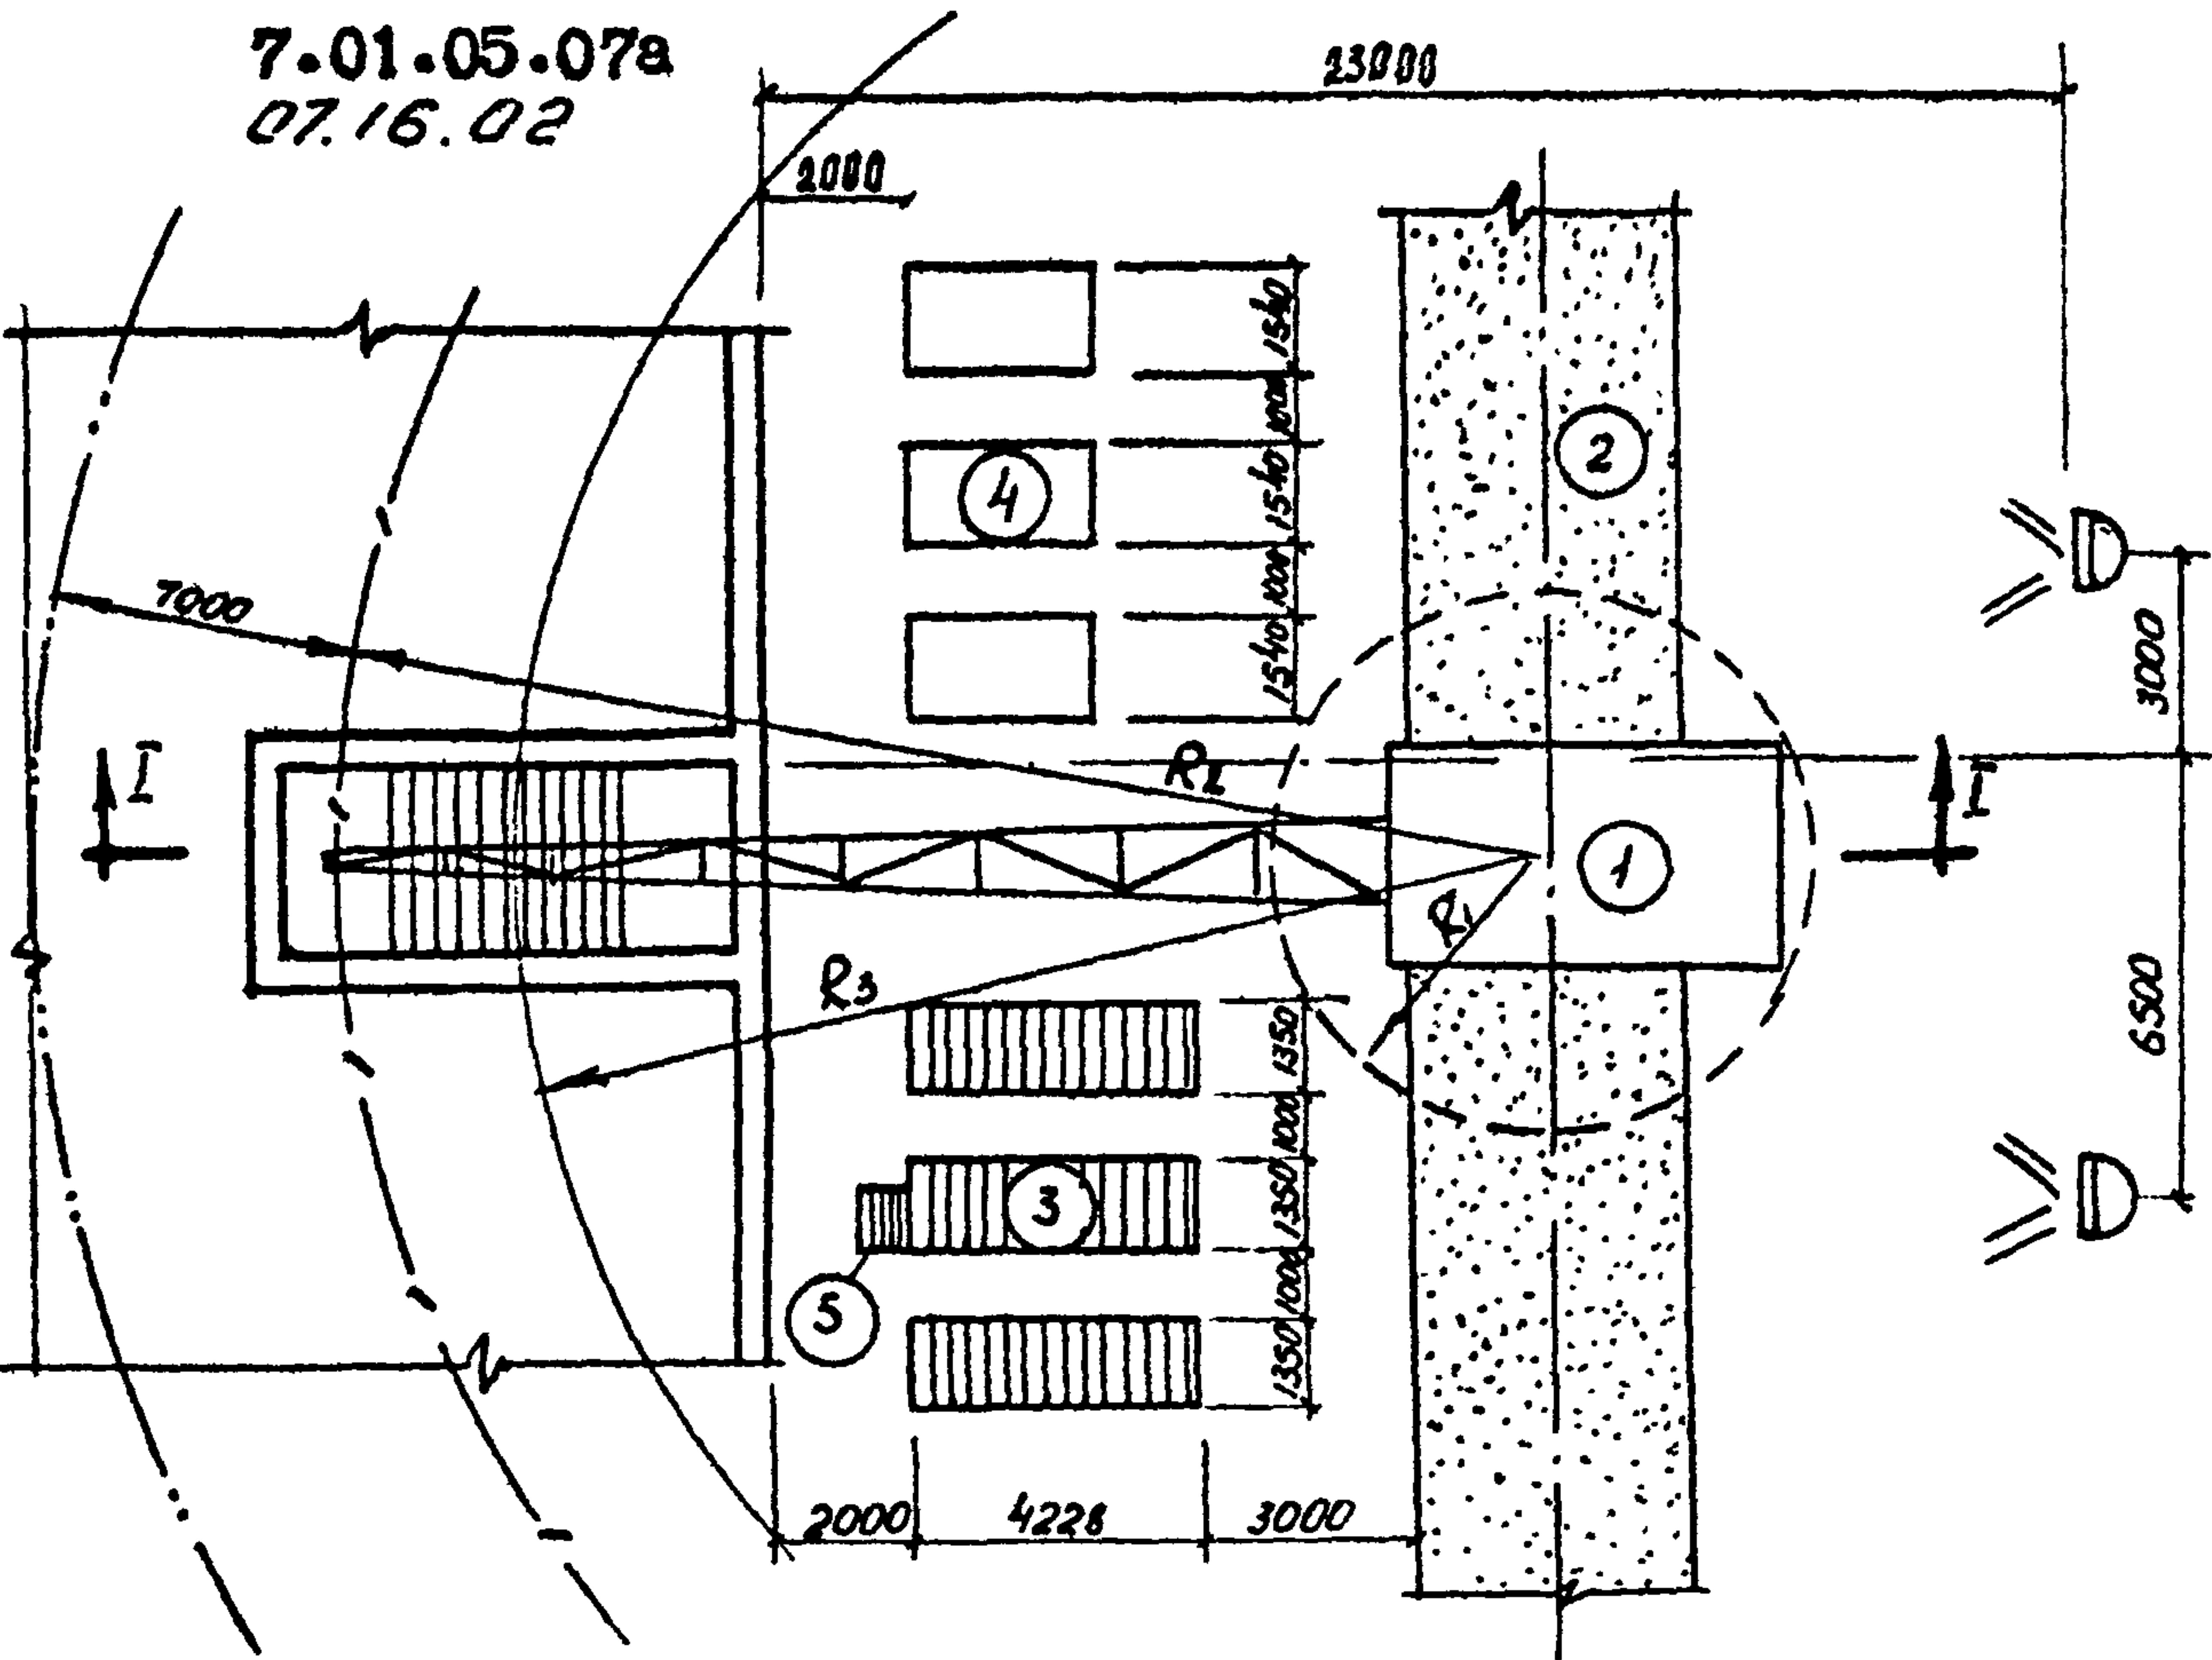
Схема монтажа лестничных маршей и площадок гусеничным краном.
